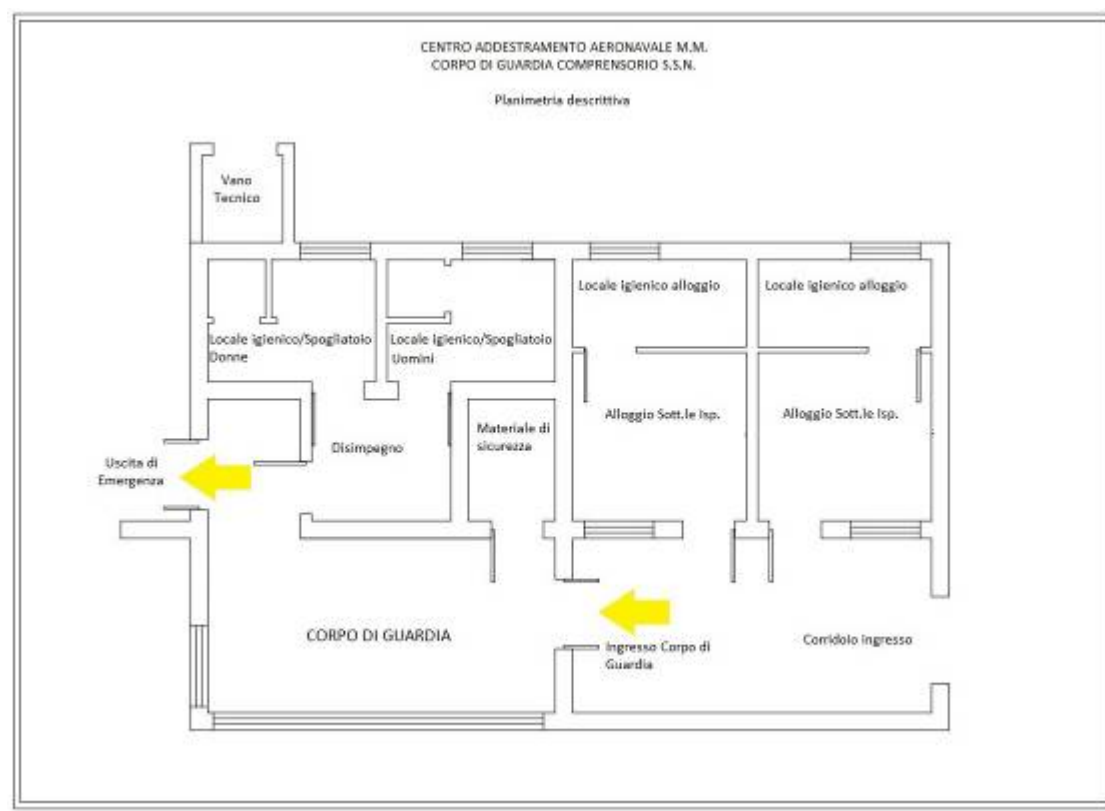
Planimetria stato di progetto descrittiva dei locali interni
